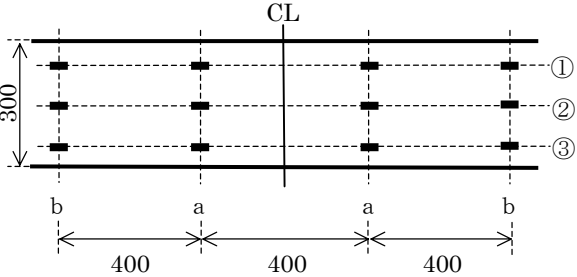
鋼上フランジ (コンクリート側) ゲージ配置図
